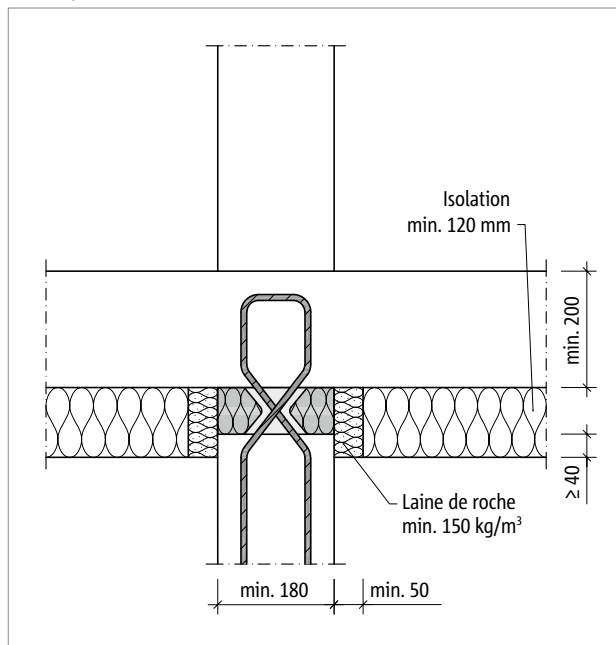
Schöck Sconnex® type W-N-VH : avec bande pare-feu en laine de roche dans la zone de l'isolation sous la dalle
